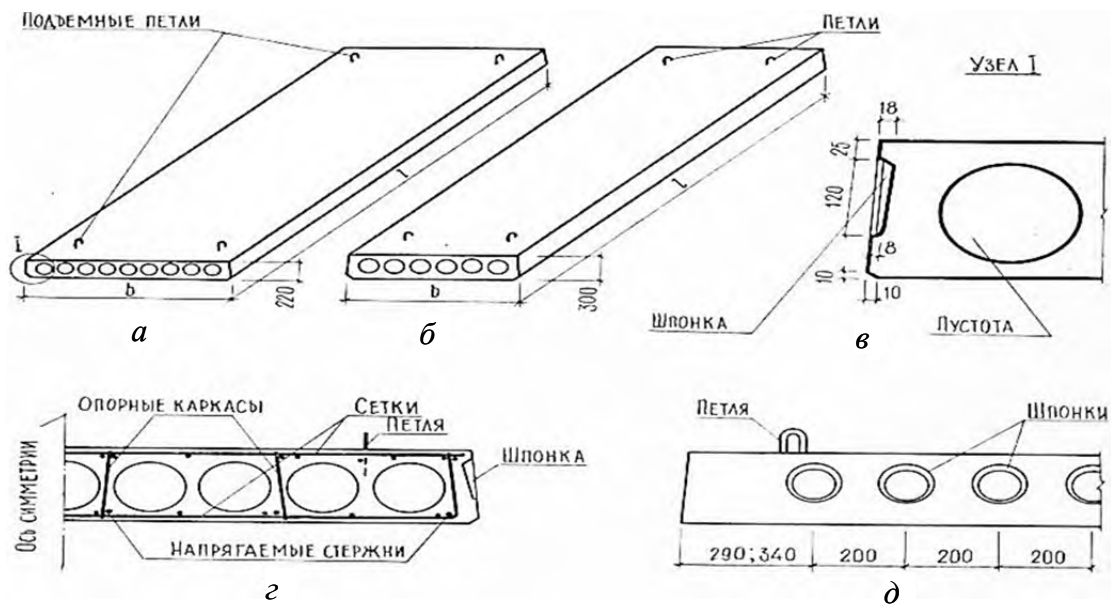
Многопустотные железобетонные плиты перекрытий:
